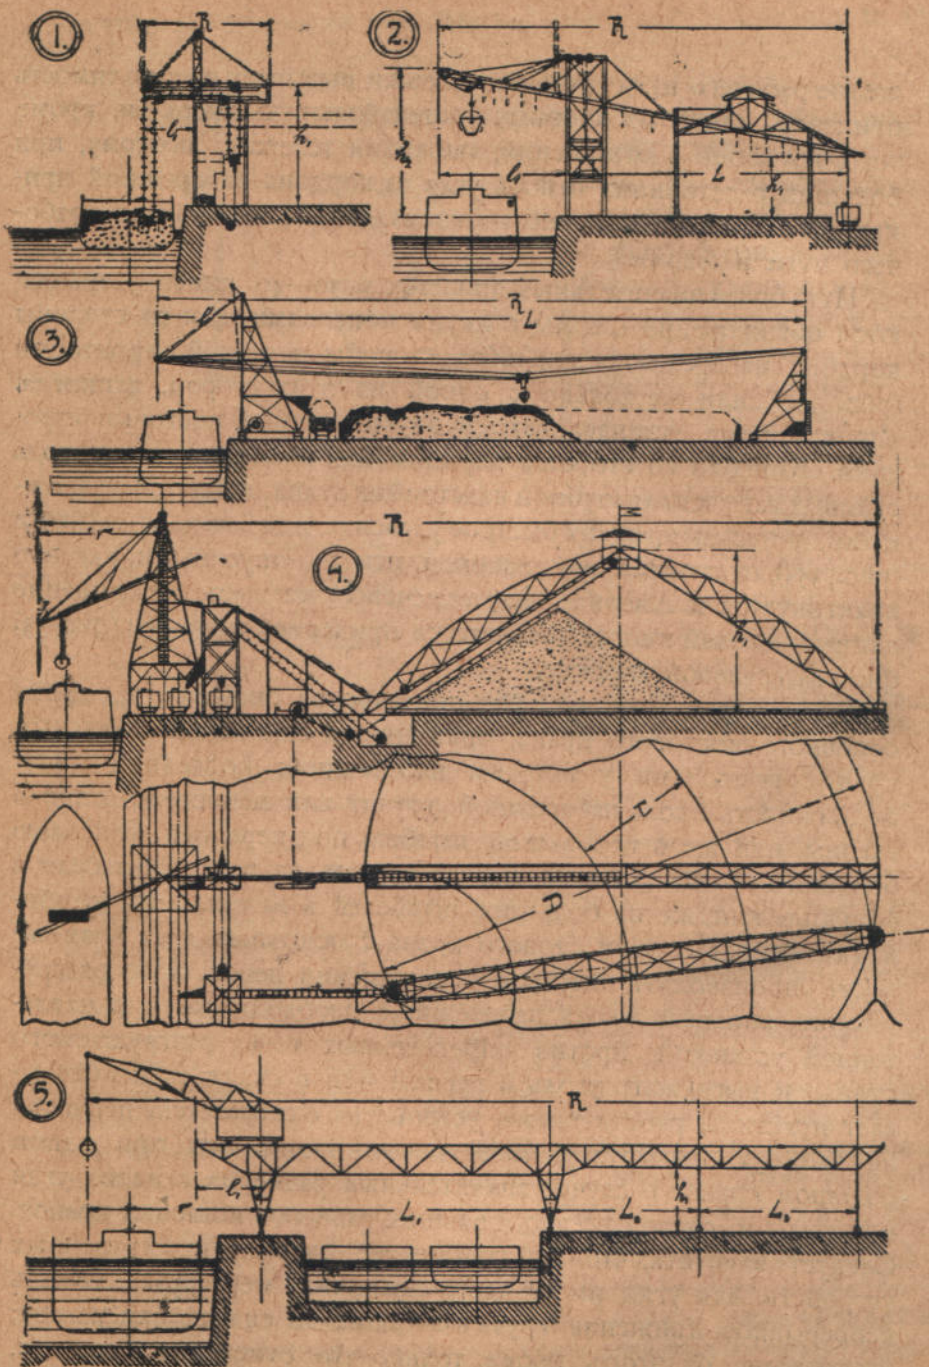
Схемы крановых установок для выгрузки угля или руды из судна на берег.
